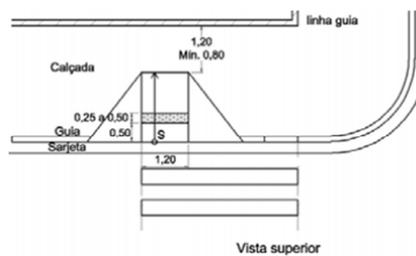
Sinalização tátil de alerta nos rebaixamentos das calçadas — Exemplo
